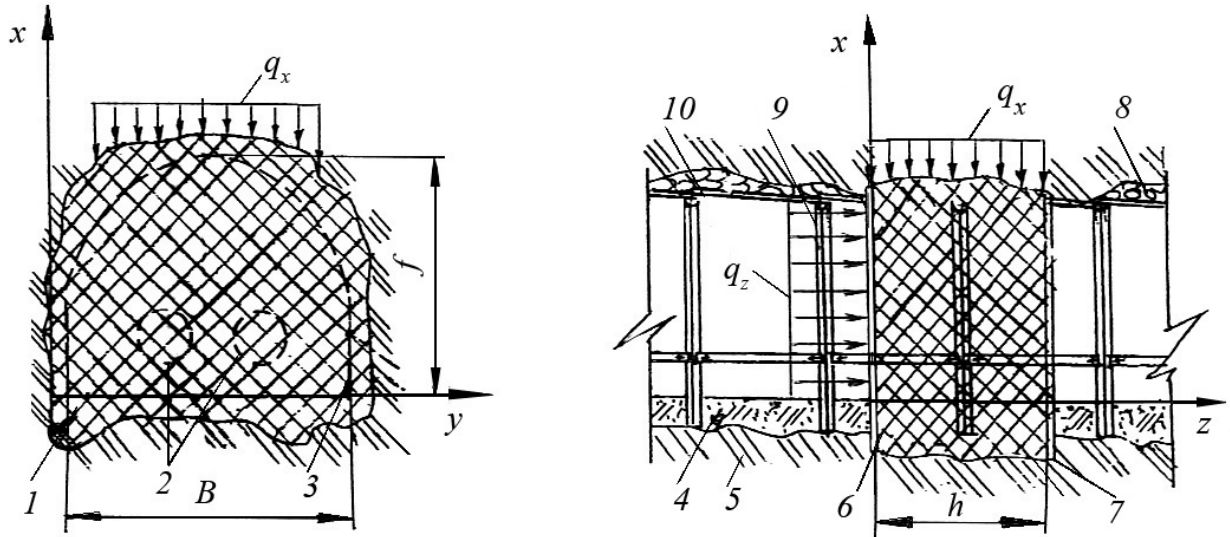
Расчетная схема взрывоустойчивой перемычки
